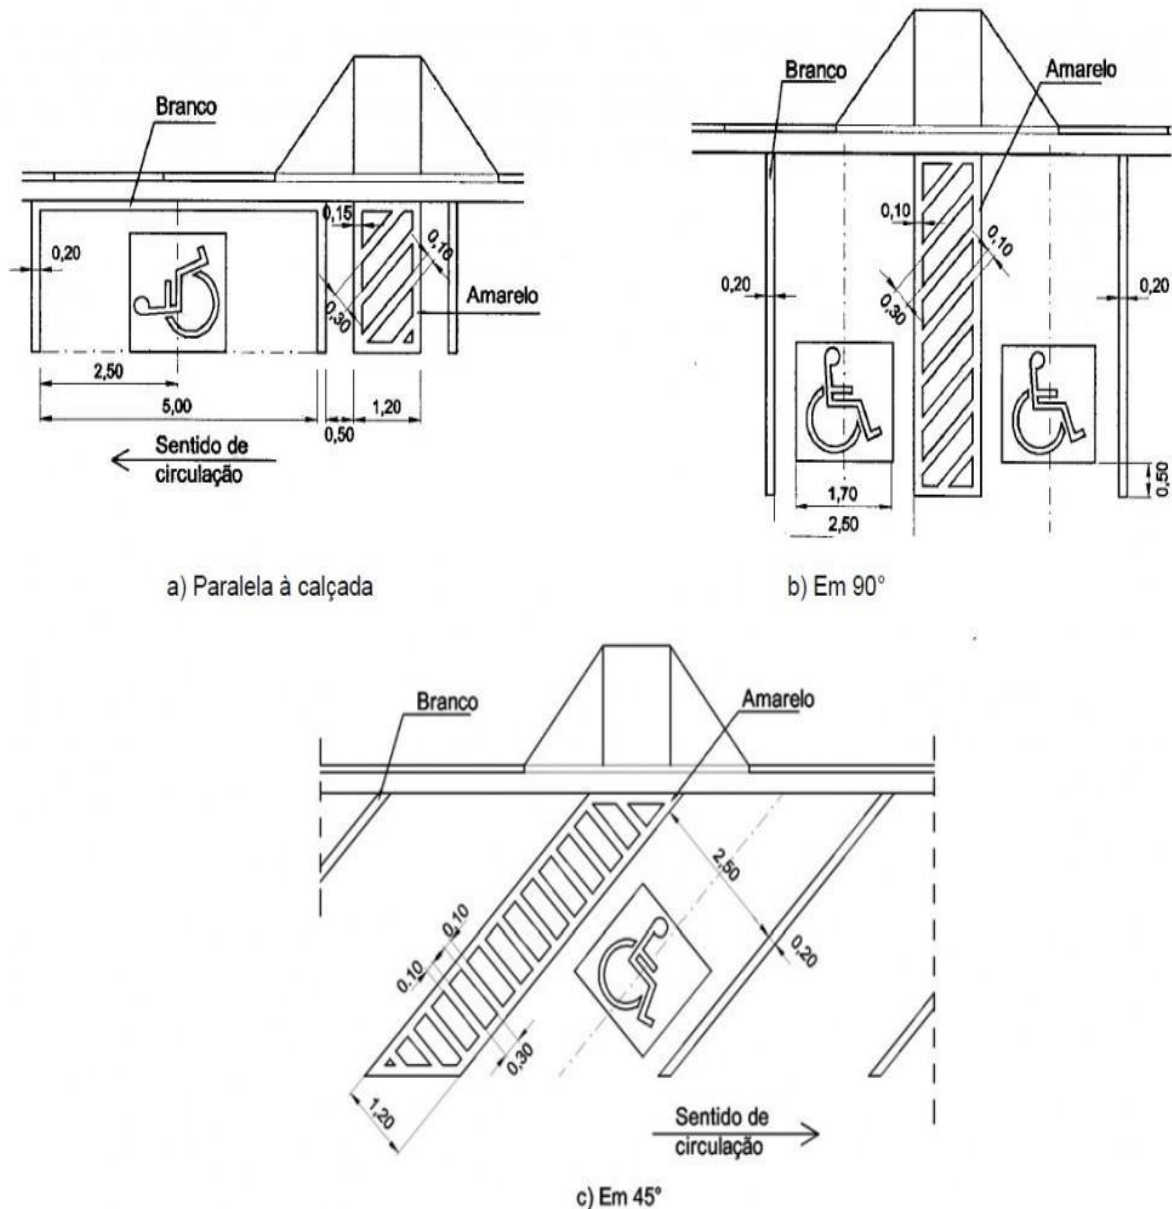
Vista em Planta dos exemplos de Vagas para Cadeirantes.
